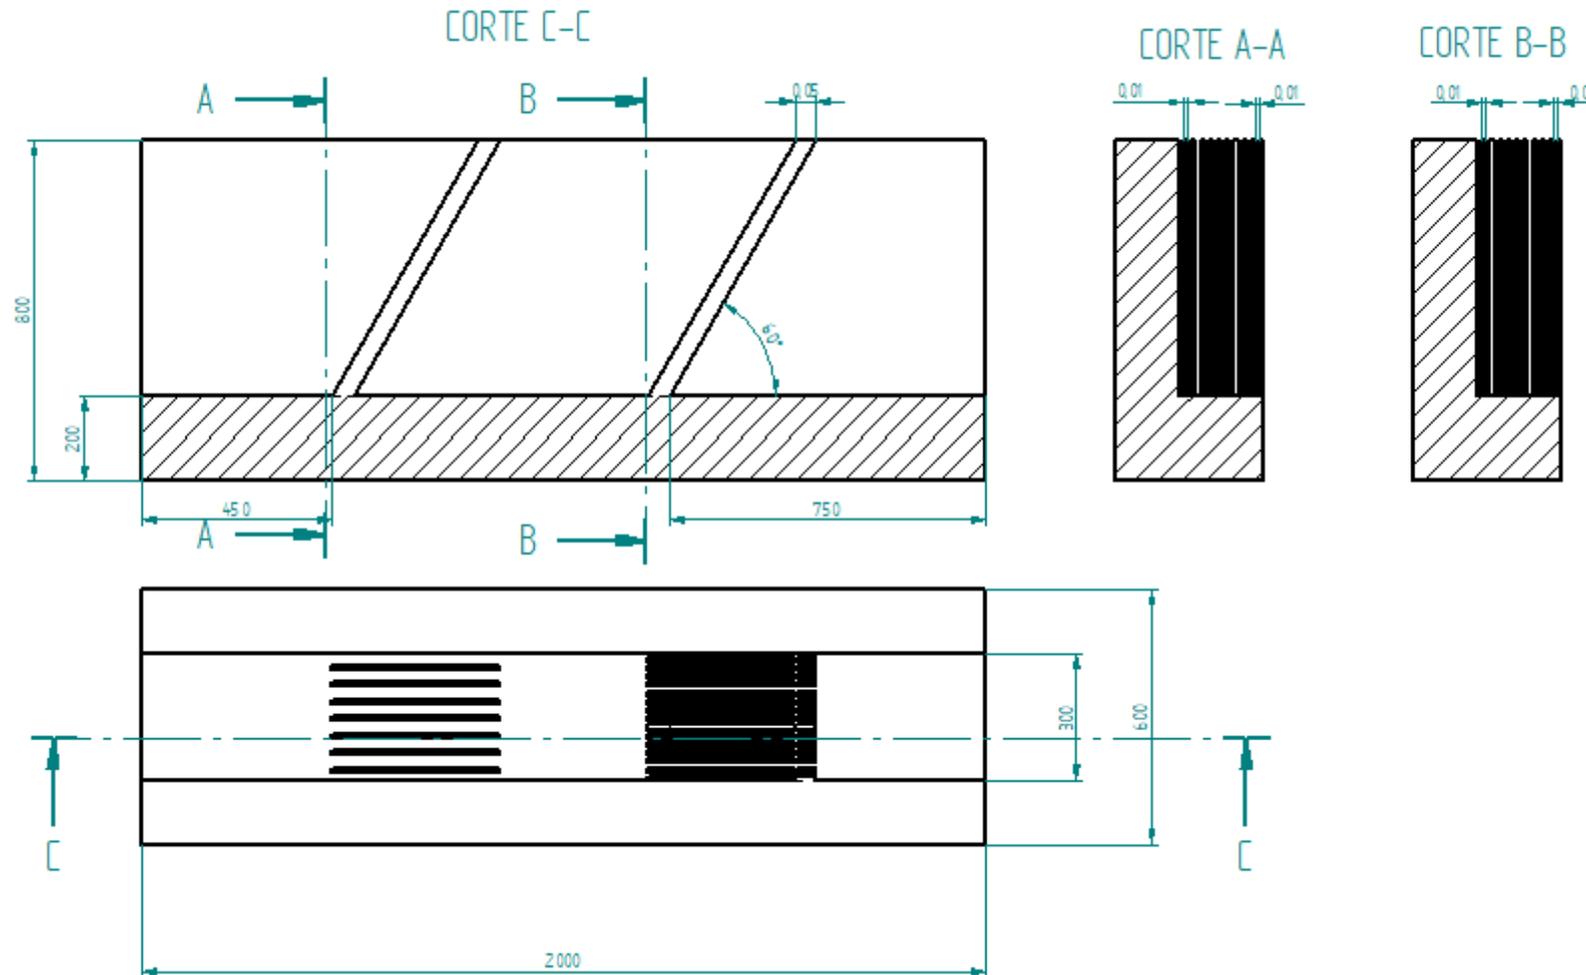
Plano constructivo del canal de desbaste (cotas en milímetros).
